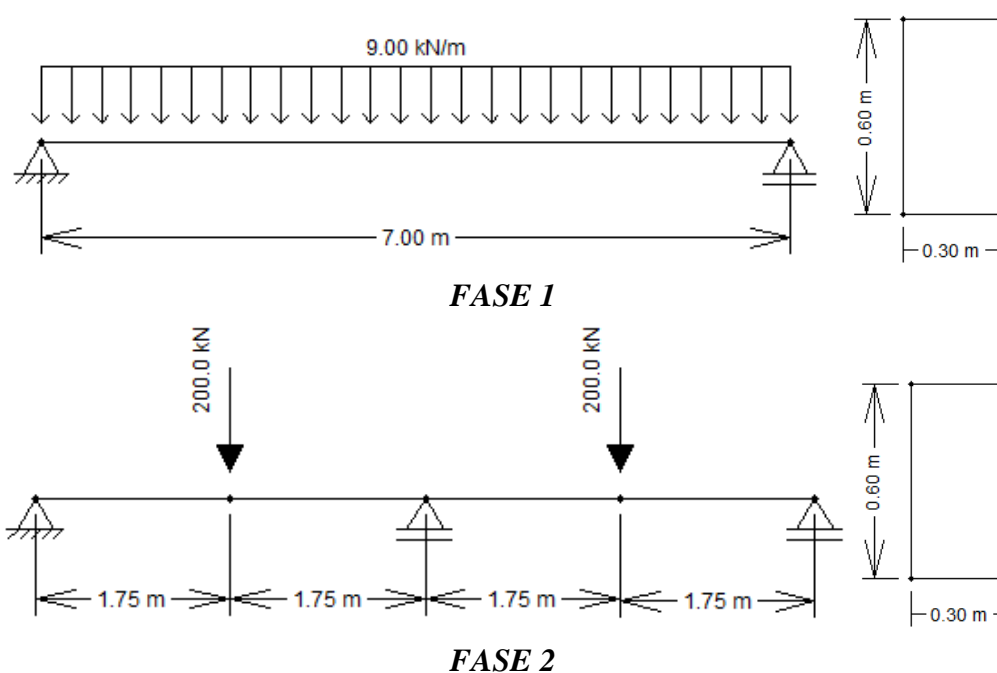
Características das etapas de execução do faseamento construtivo.
